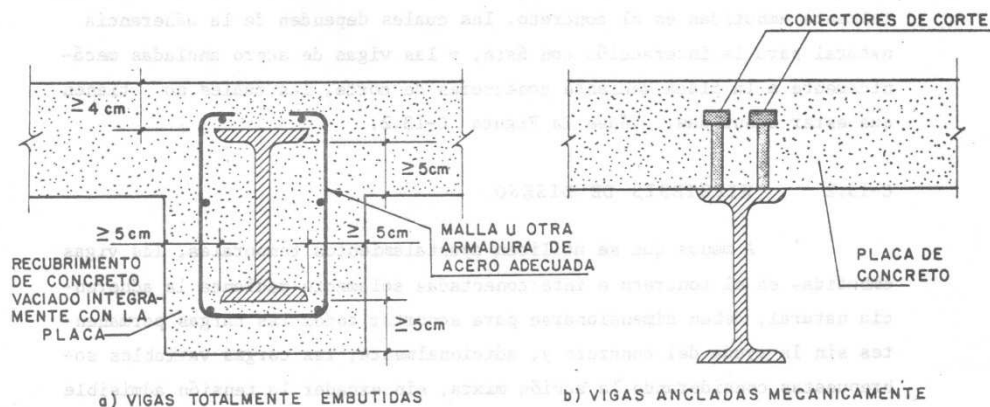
TIPOS DE CONSTRUCCIONES MIXTAS
